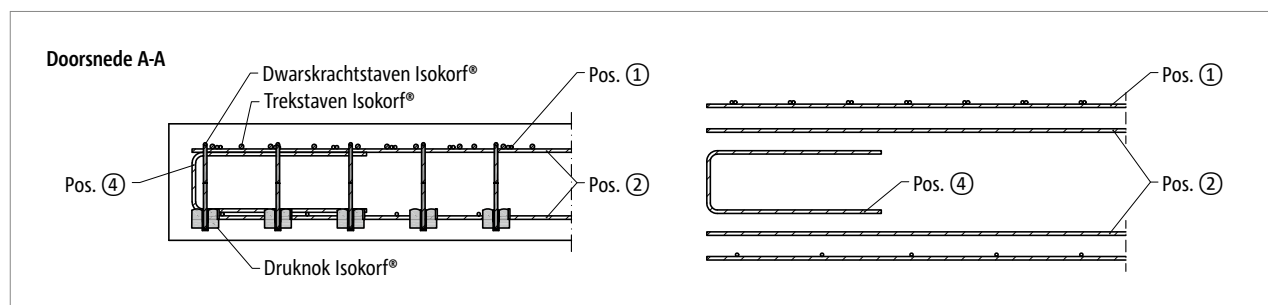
Schöck Isokorf® XT type K-E-M8: Doorsnede
